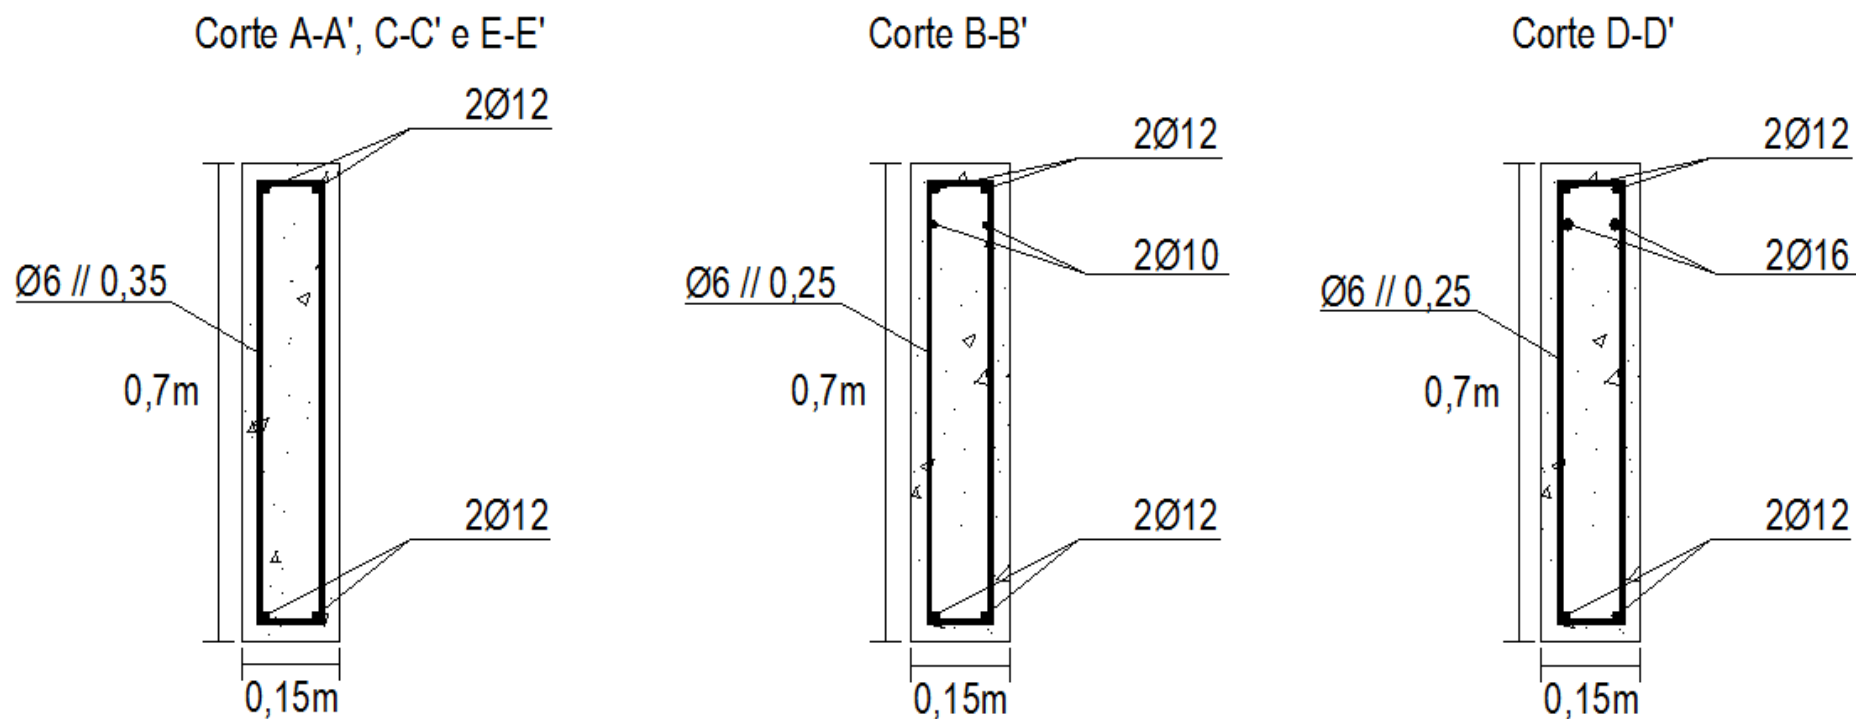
Cortes transversais viga Pórtico 1-1' – piso 1
